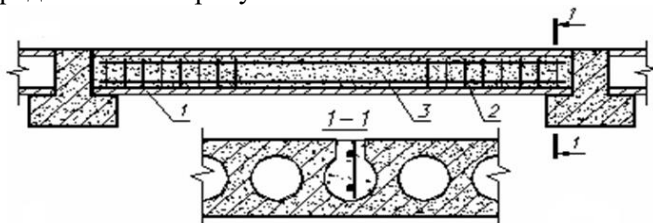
Вариант усиления многопустотной плиты перекрытия установкой дополнительной арматуры: 1 – плита; 2 – сварной каркас; 3 – бетон
